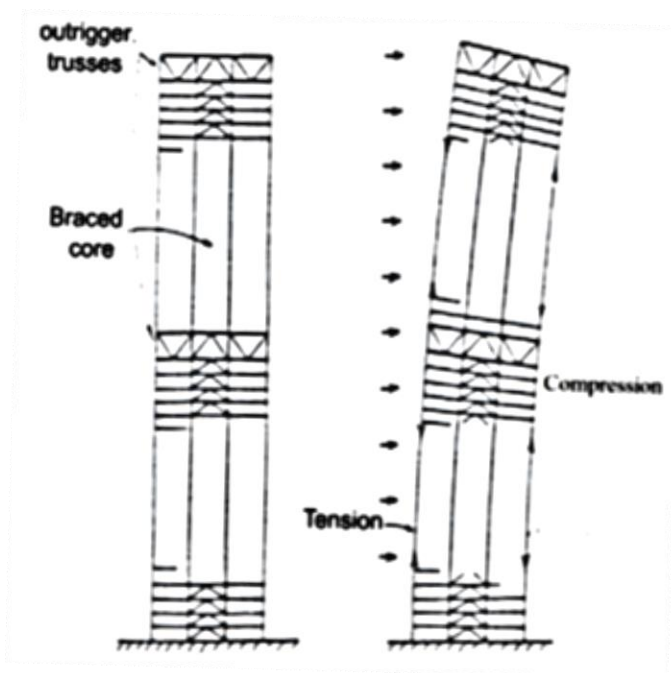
Corte esquemático de edifício com outriggers (Hallebrand & Jakobsson, 2016)
